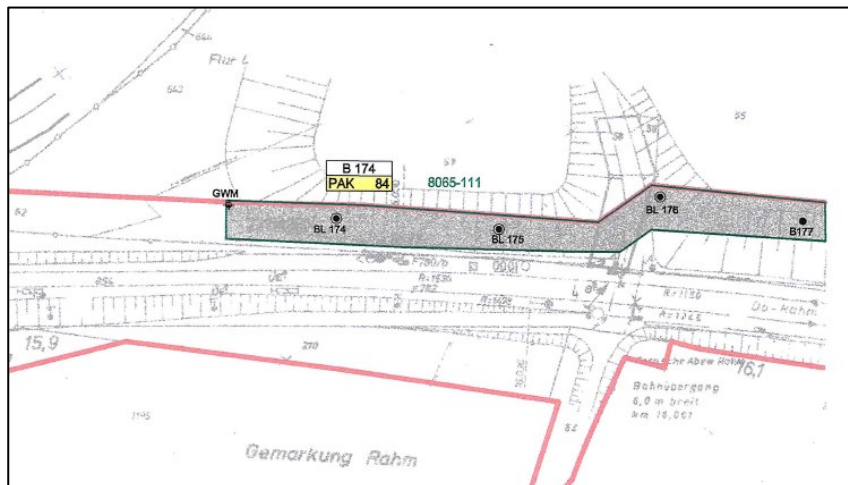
Lageplan Bohrungen ALVF B-008065-111 (OU, 1999)
